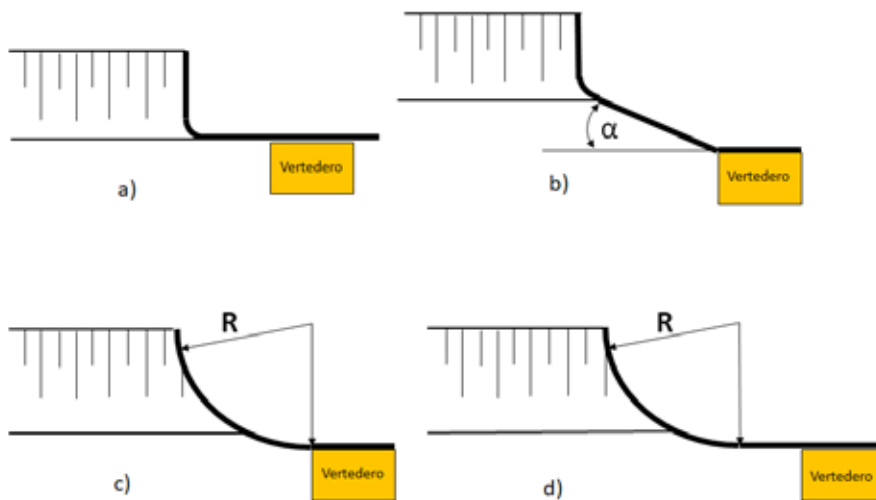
Vista en planta de muros de ala. Fuente: Kirienko (1987)
